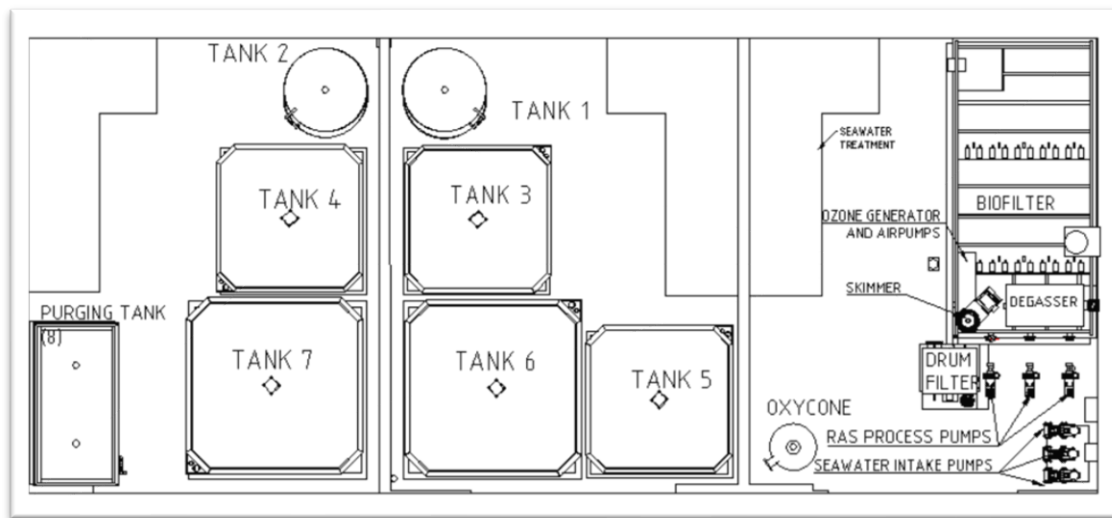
Planta térrea dos 3 armazéns adjacentes do edifício
